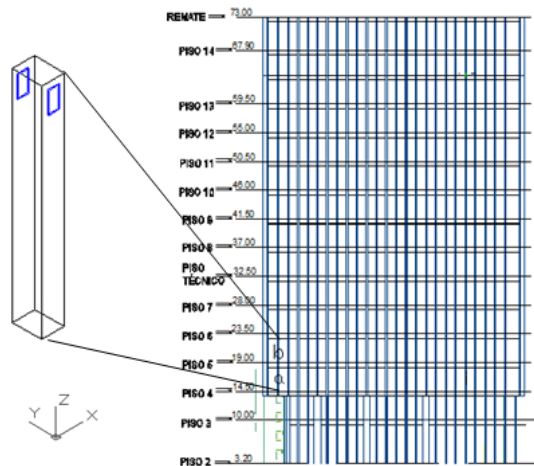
Ubicación galgas extensométricas en Columna Fachada de 6 mm costado frontal de la estructura
